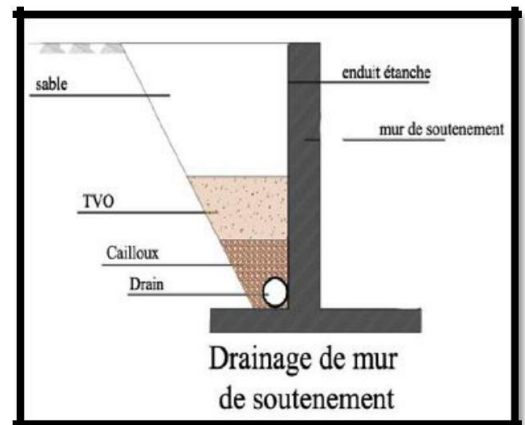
drainage de mur de soutènement Source : <http://www.adets.fr>
